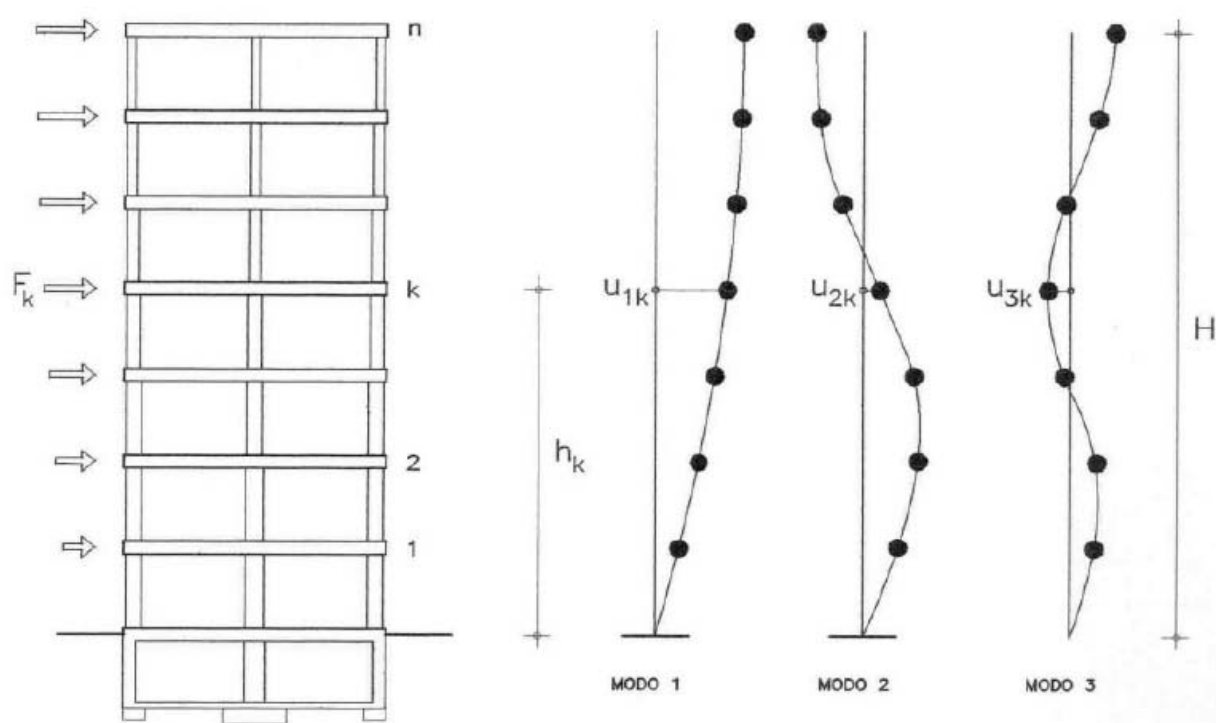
Modos de vibración en modelos planos de estruturas de pisos
